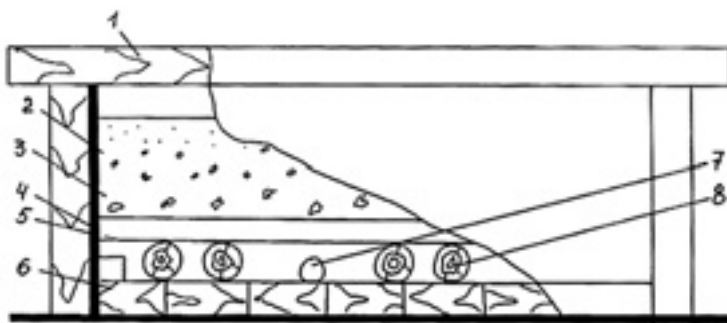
Конструкция песчаного (шлакового) фильтра: 1 – крышка для досок «вразбежку»; 2 – песок (шлак); 3 – гравий; 4 – герметическая обмазка; 5 – накат из бревен; 6 – деревянный короб; 7 – трубопровод; 8 – подкладка из бревен
